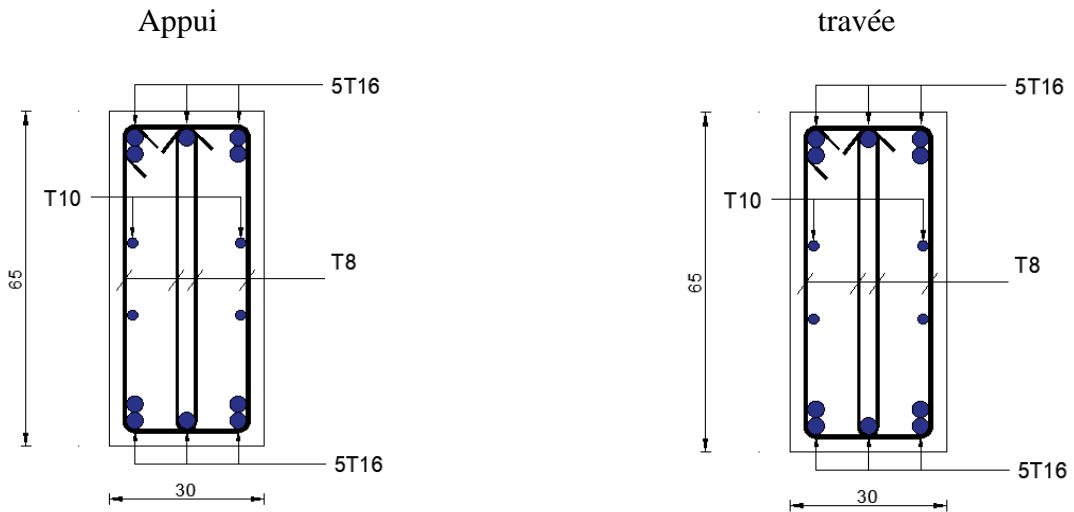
schéma de ferrailages des poutres principales 1 (6^{ème} étage---RDC)
